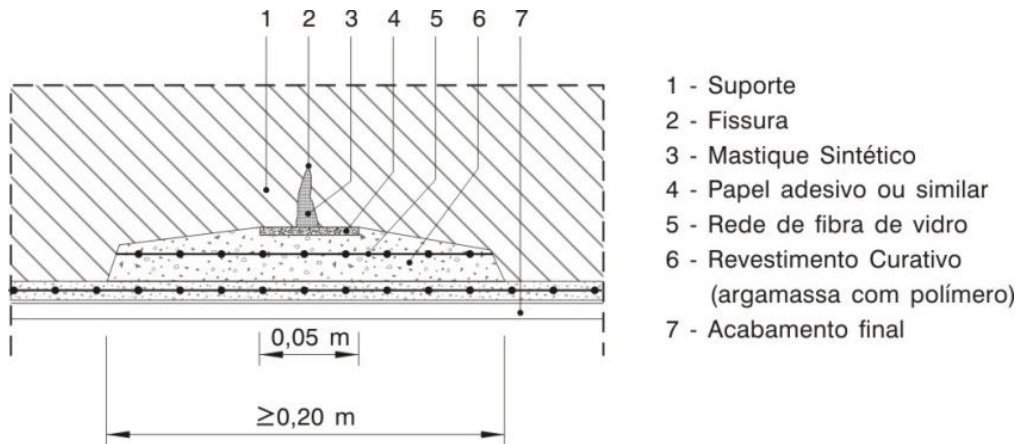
Esquema de reparação de fissuras pronunciadas
